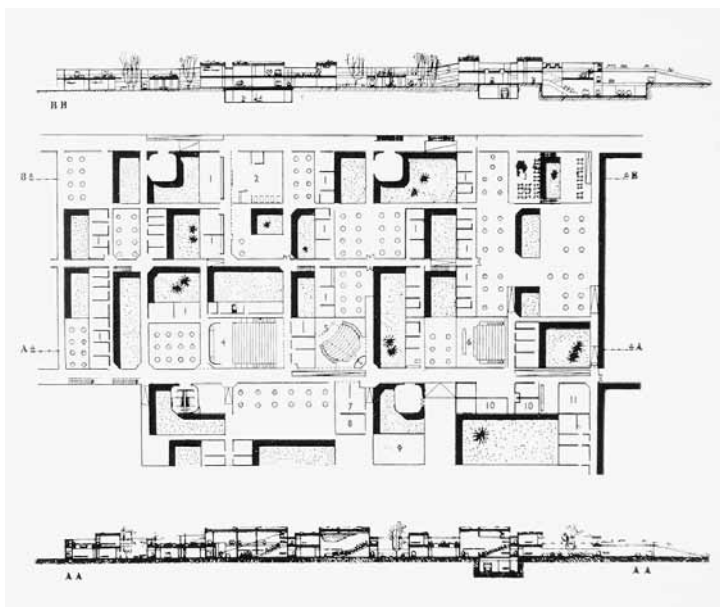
Candilis Josic y Woods, *Freie Universität, Berlin* (1964): planta, alzado y sección. Tomado de Sarkis, Case.
